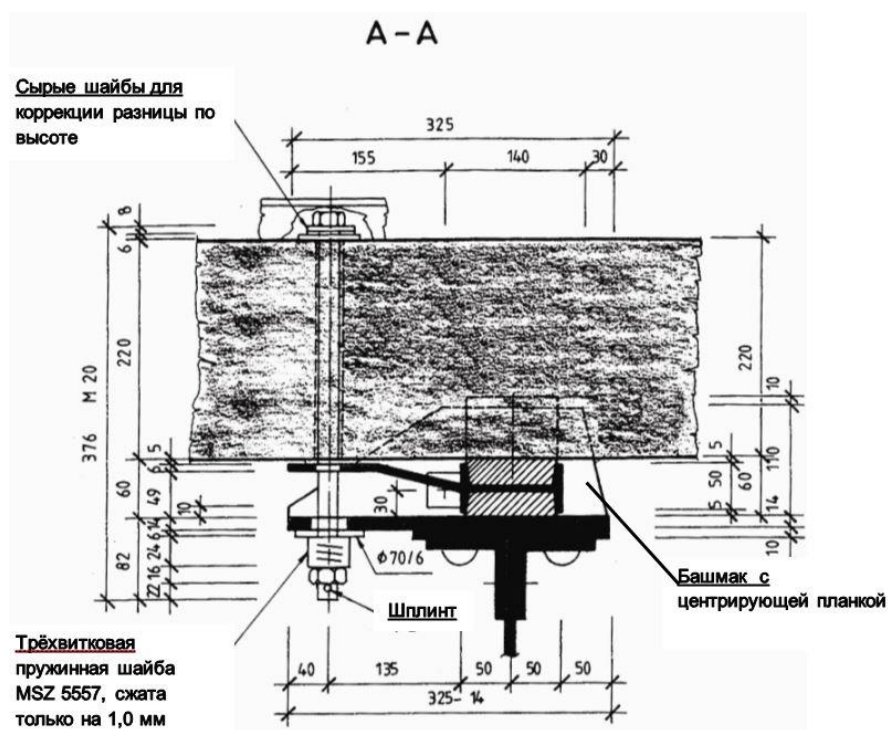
Поперечный вид конструкции прокладного шара под железобетонным брусом.
